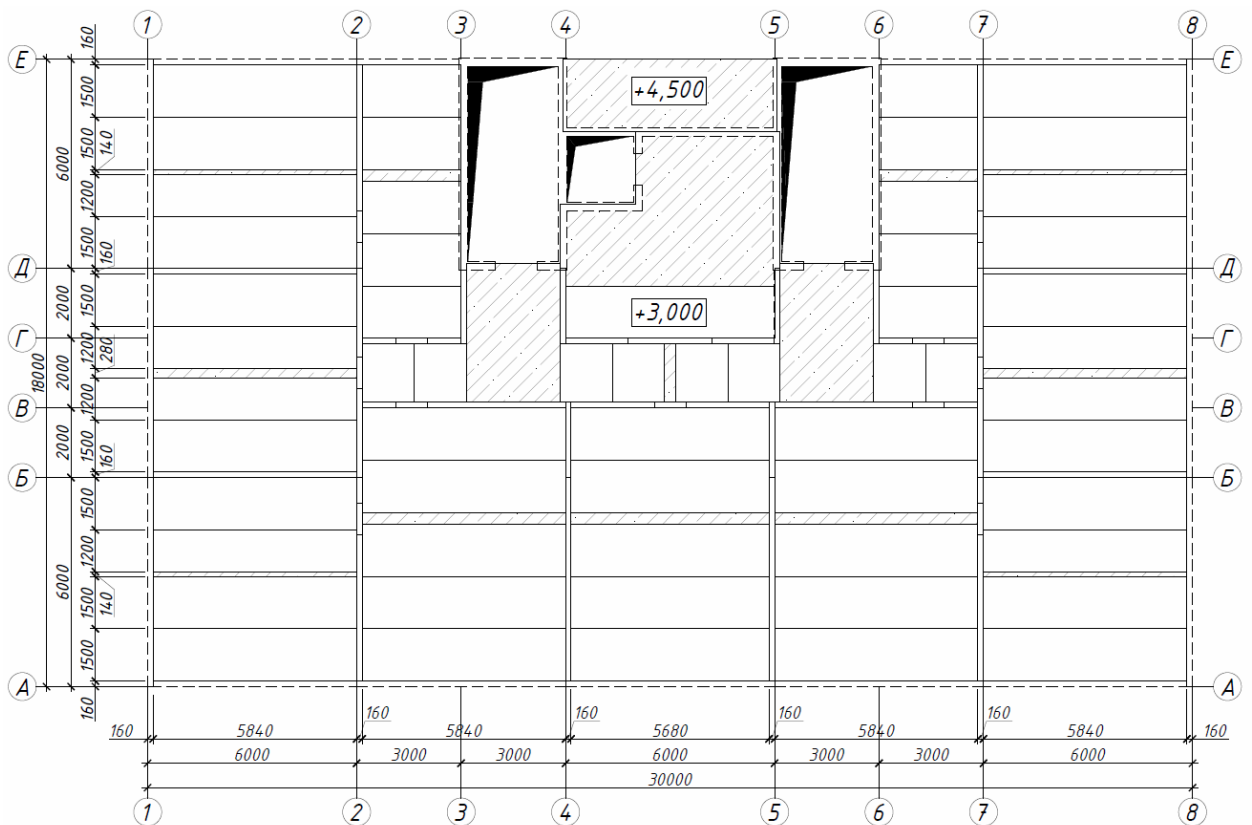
Схема перекриття із несучими стінами по цифрових осях
